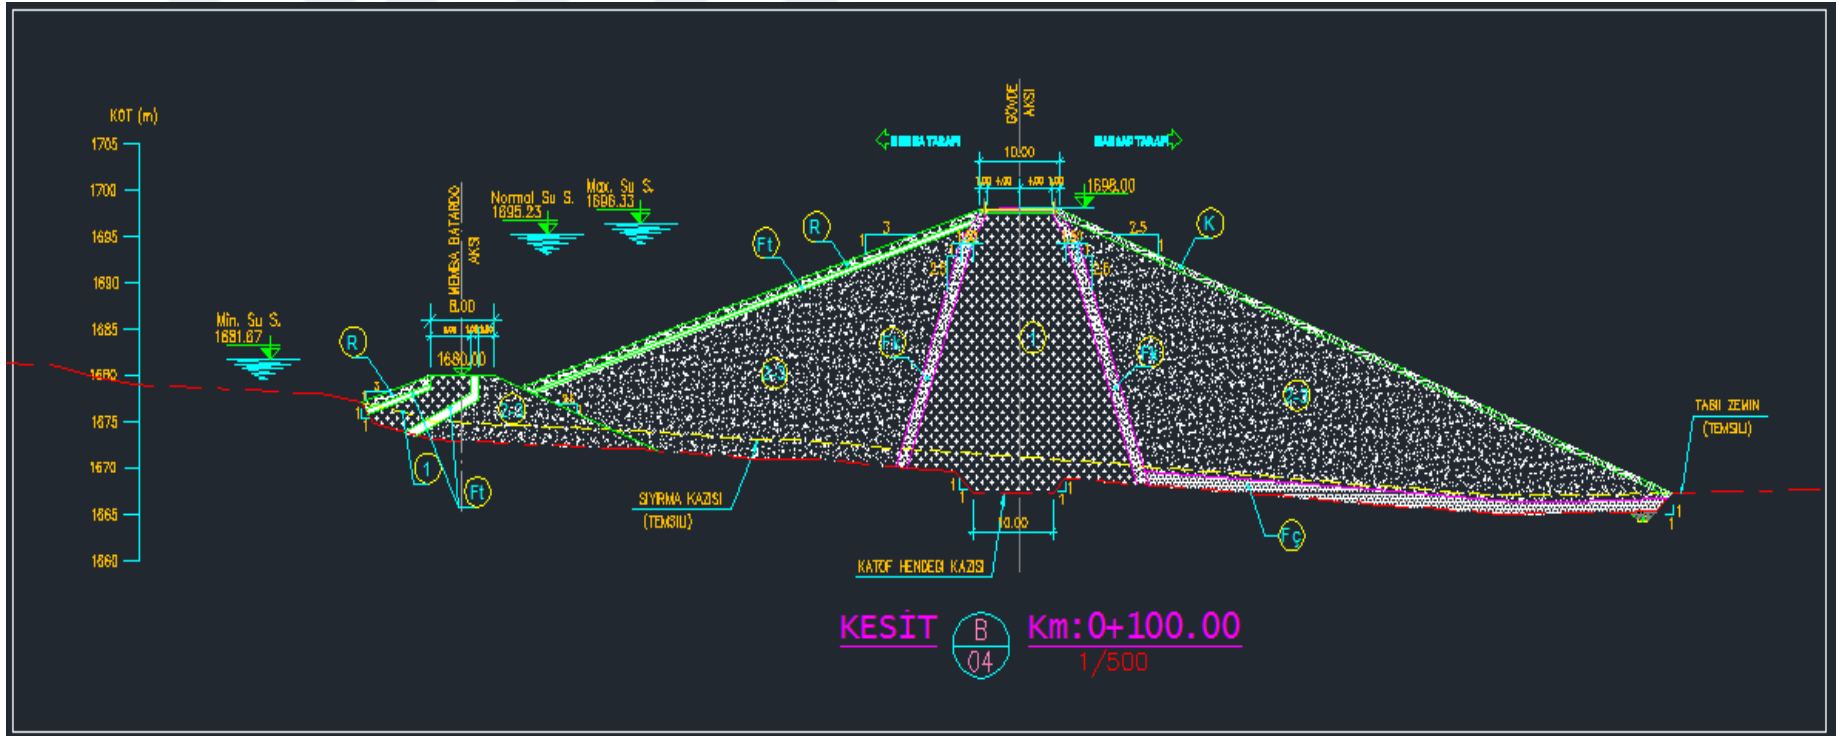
Gölet vaziyet planı (kil çekirdekli kum-çakıl dolgu)
